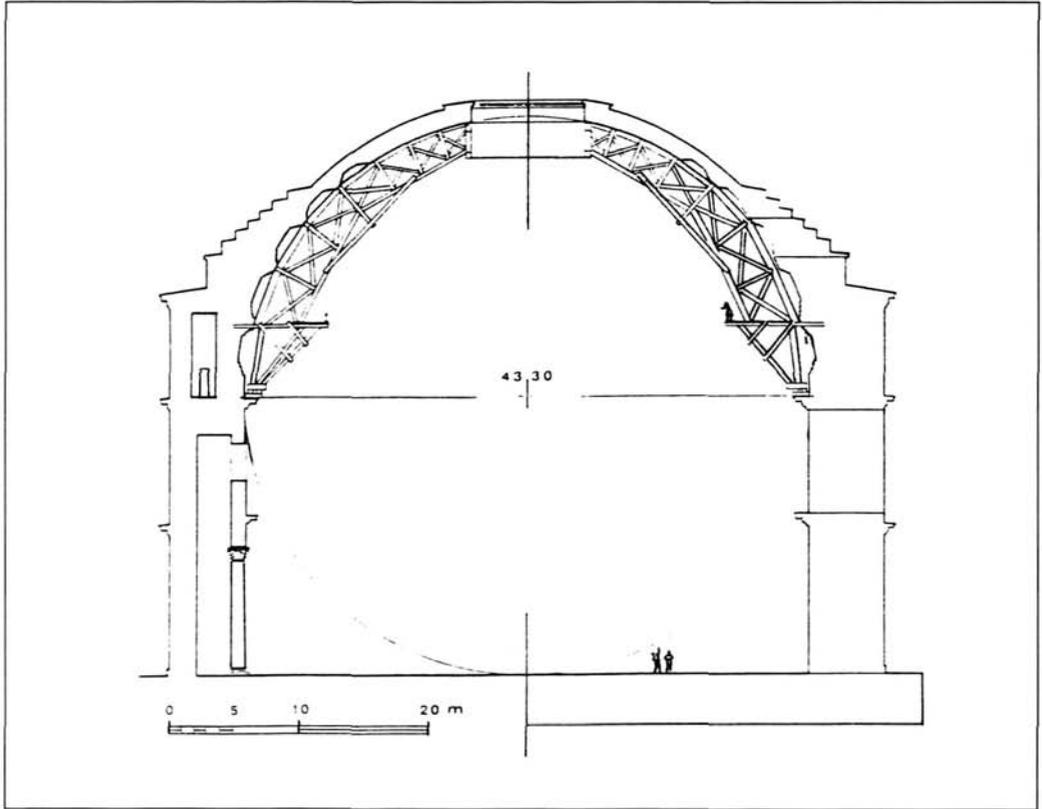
Cimbra de madera para la construcción de una cúpula.(J. P. Adam)
